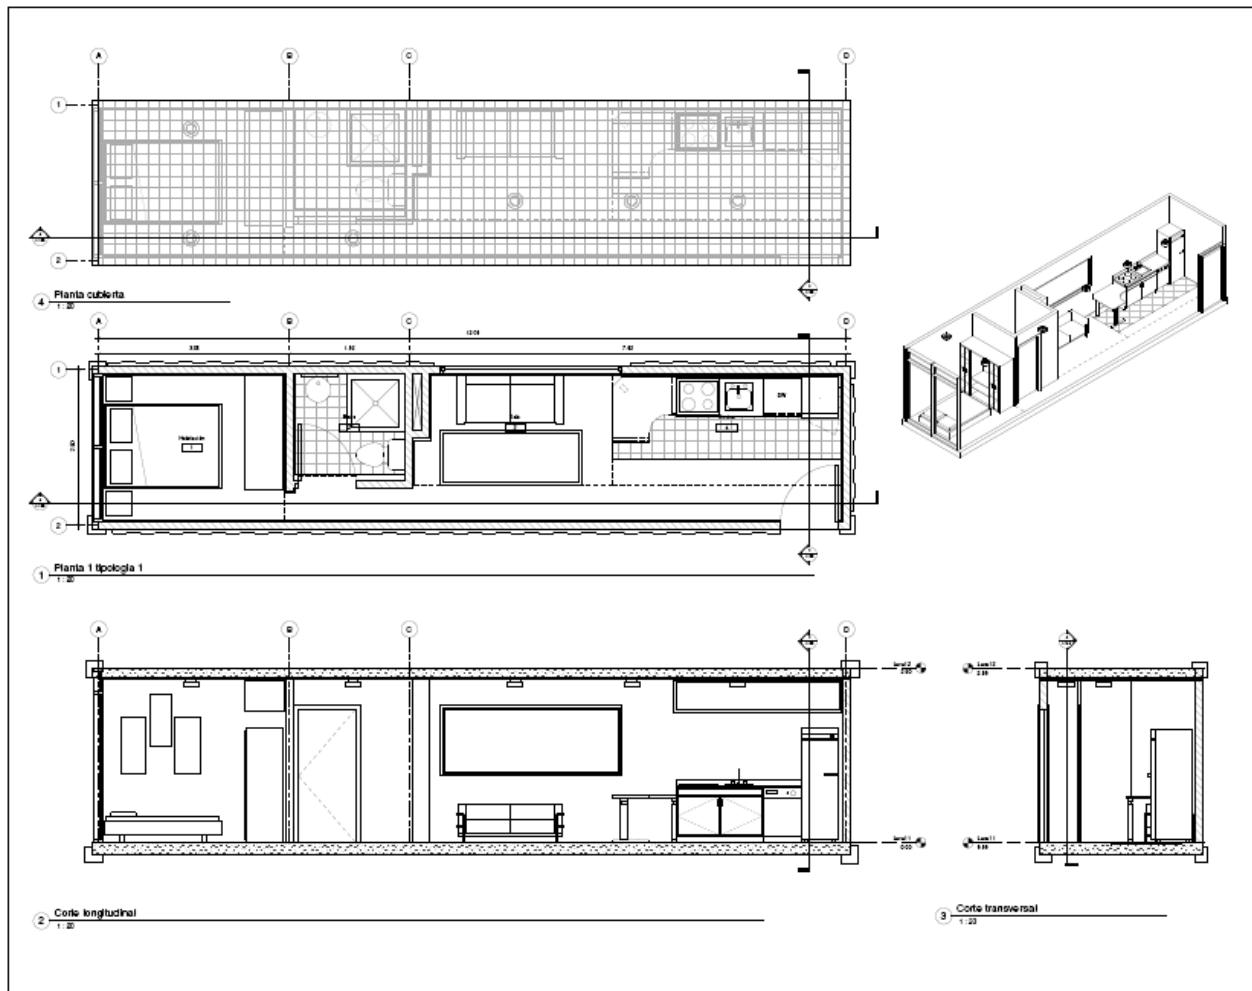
Anexo de plantas, cortes y vistas 3d de la tipología 1 - Fuente propia.
